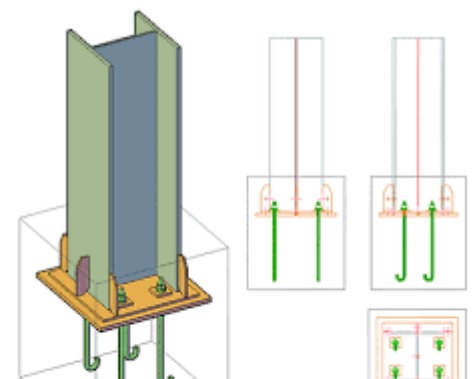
Schéma présente la jonction entre l'acier et le Béton. Source : Pinterest
